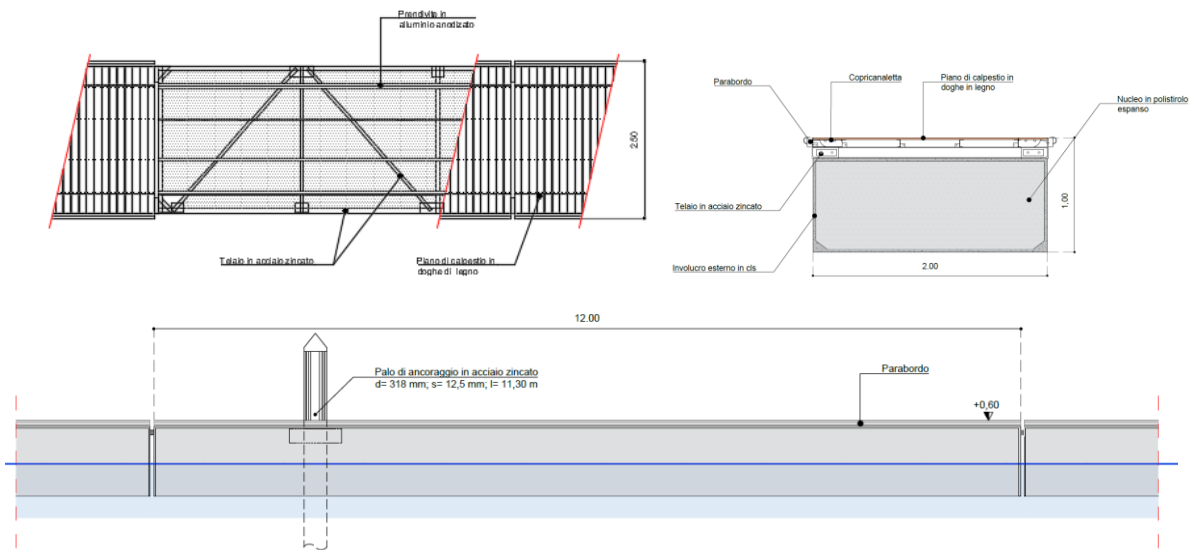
Pontile galleggiante tipo -GALLEGGIAMENTO CONTINUO
